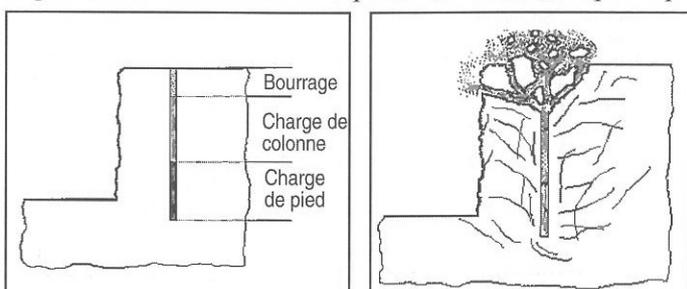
Risques de projections verticales en cas d'insuffisance de la hauteur de bourrage.
